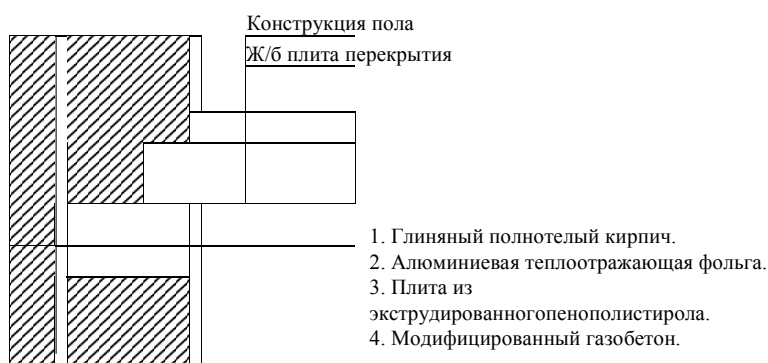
Конструктивная схема наружной стены жилого дома.
